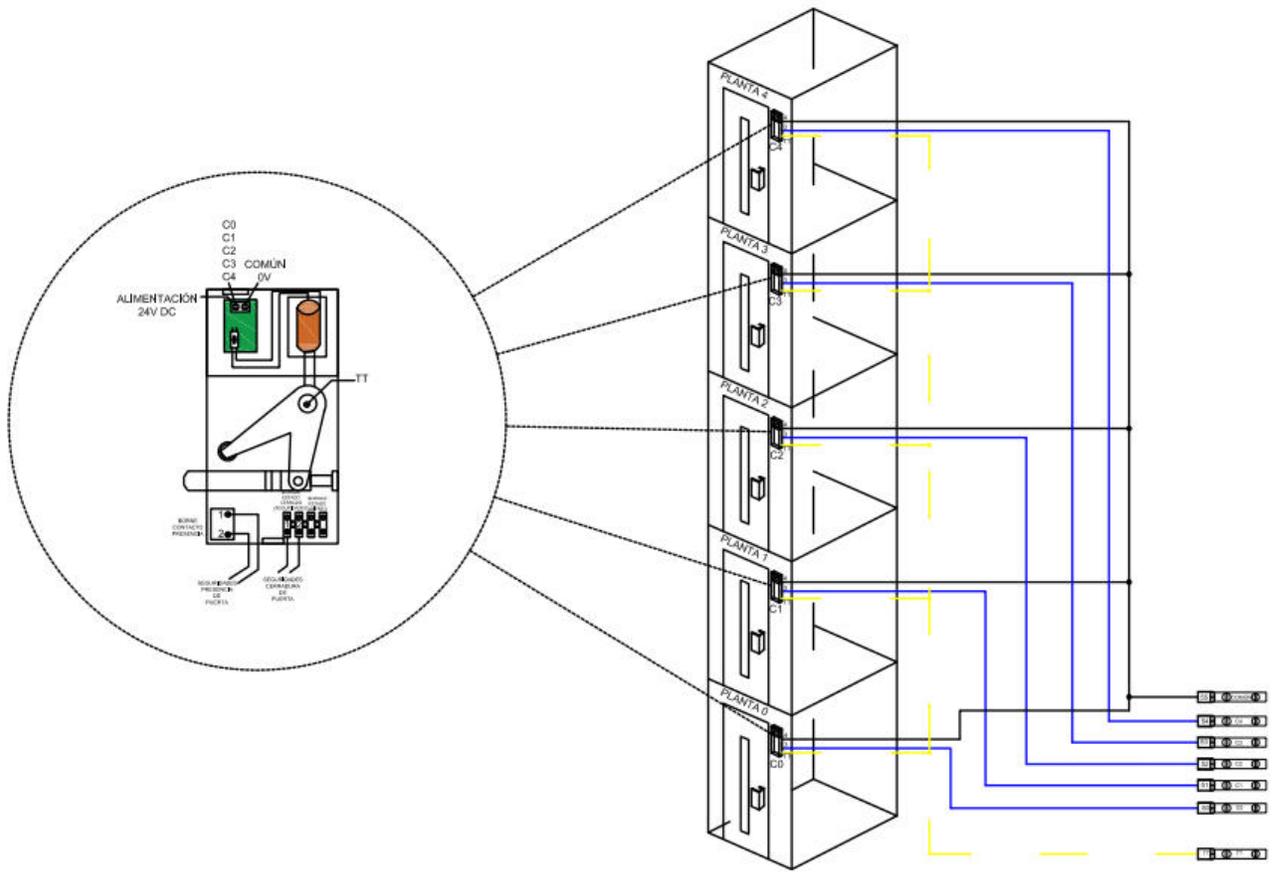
Plano frontal de conexiones de cerradura y finales de carrera
